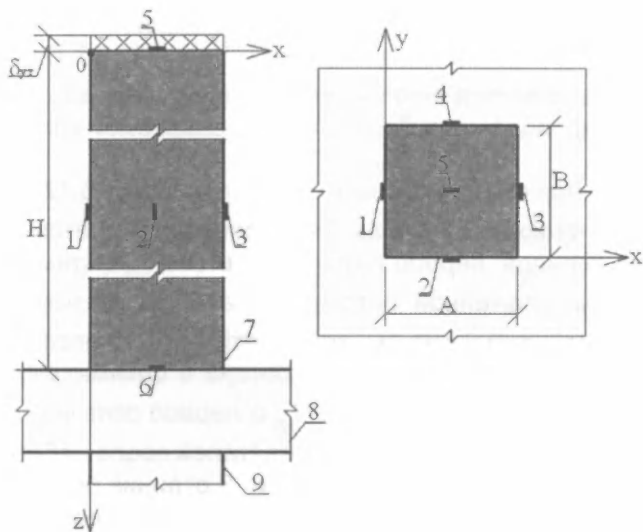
Расчетная схема бетонированной одиночной колонны монолитного каркаса
